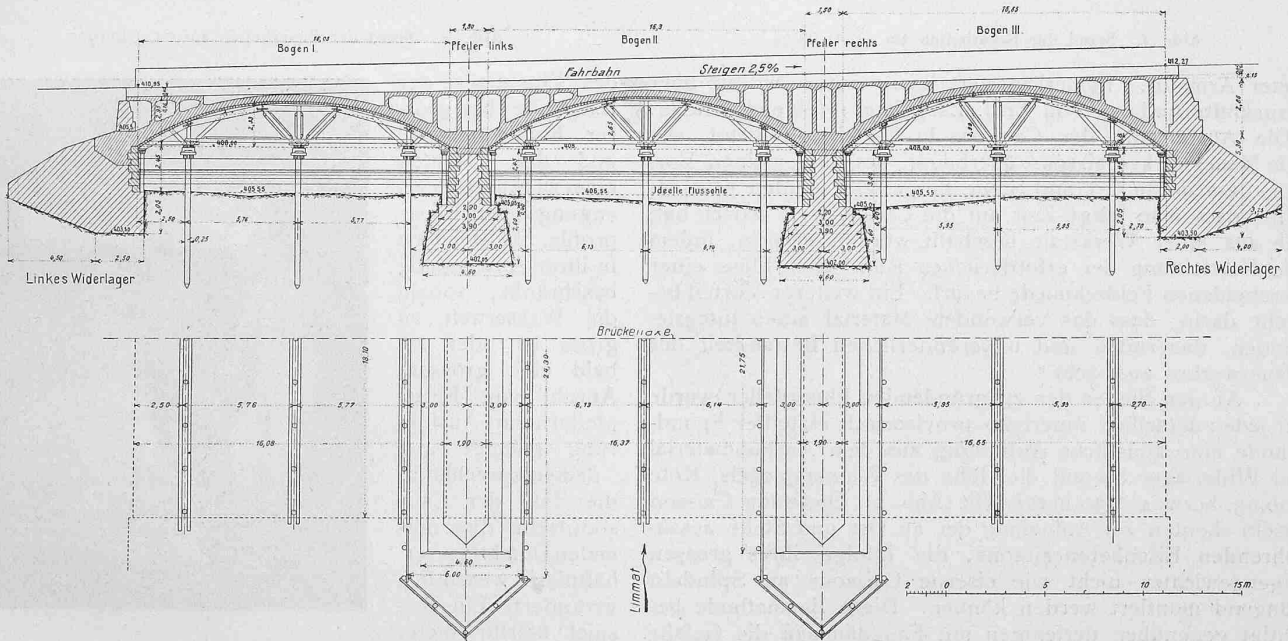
Die Walchebrücke in Zürich. — Längsschnitt und halber Grundriss. — Masstab 1:350.
